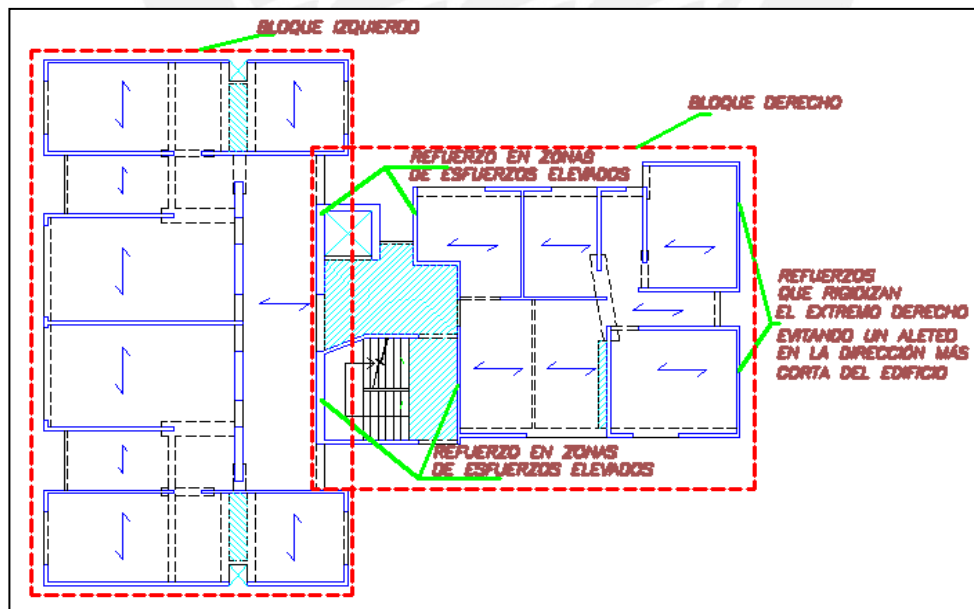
a: Refuerzos en zonas de esfuerzos elevados y en el bloque derecho
